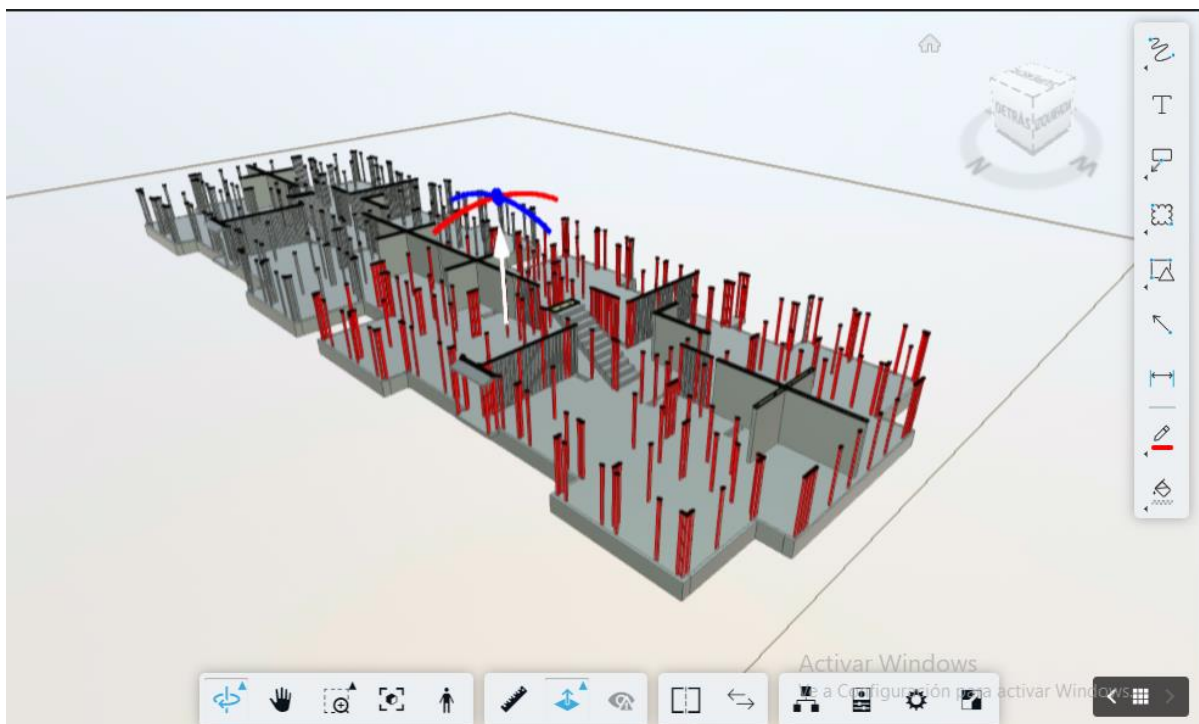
Plano Revit, Sistema Estructural Torre de 54 m².
